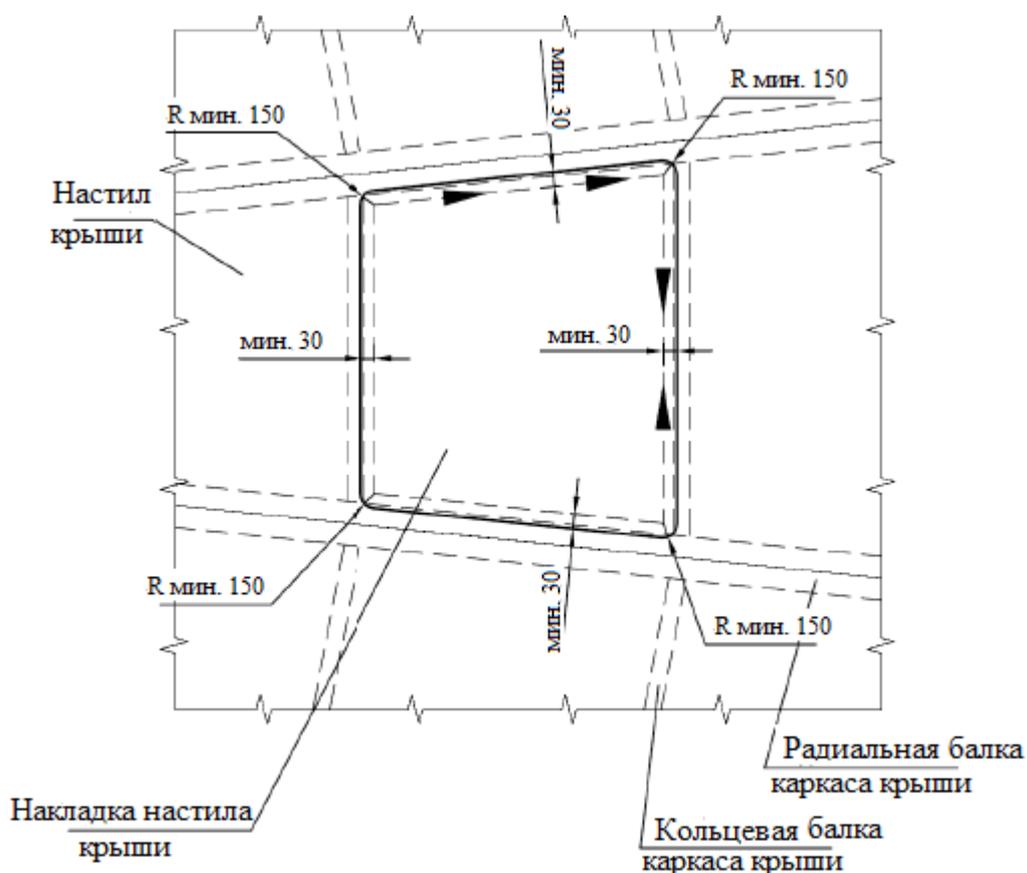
Установка новой накладки на настиле крыши
